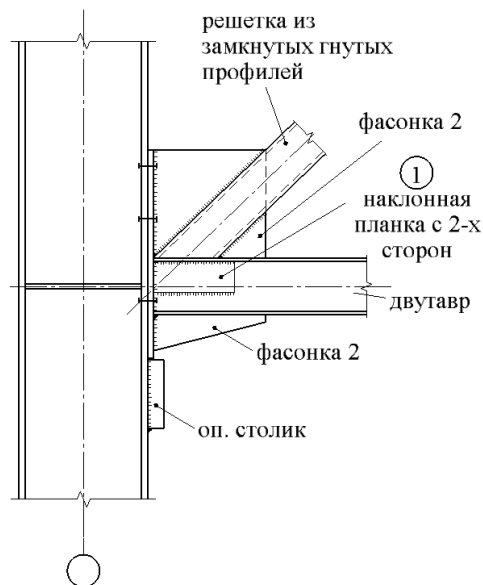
Узел примыкания к колонне фермы с поясами из двутавров, решеткой из замкнутых гнутых профилей
